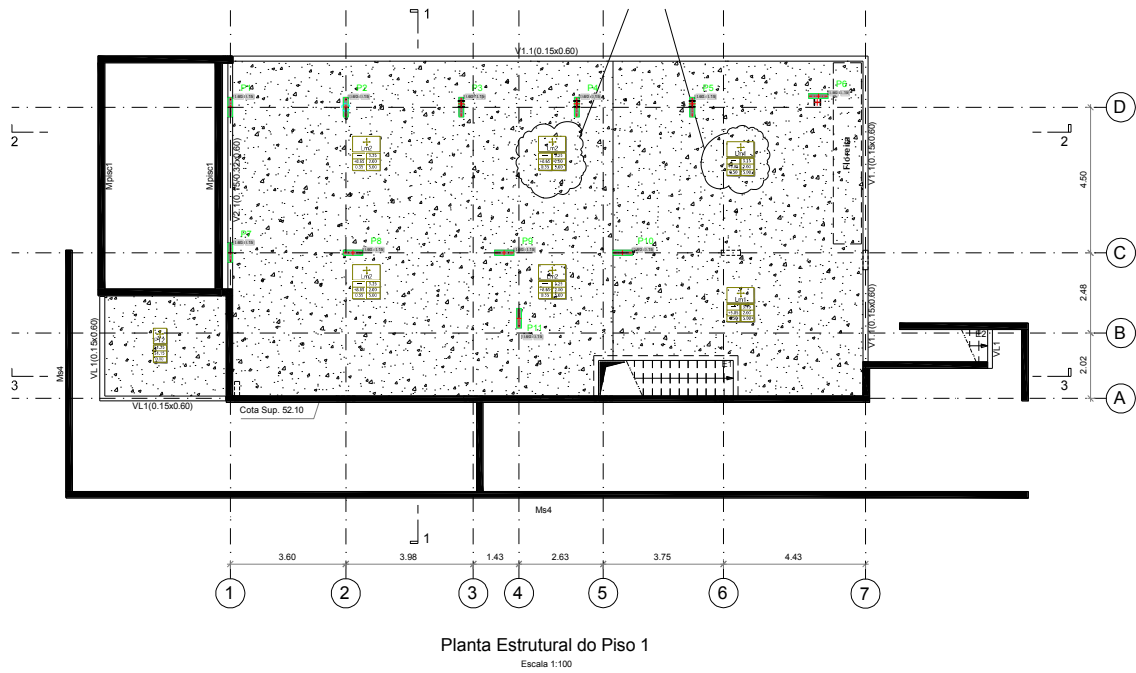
PLANTA ESTRUTURAL DO PISO 1 (AUTOCAD)
